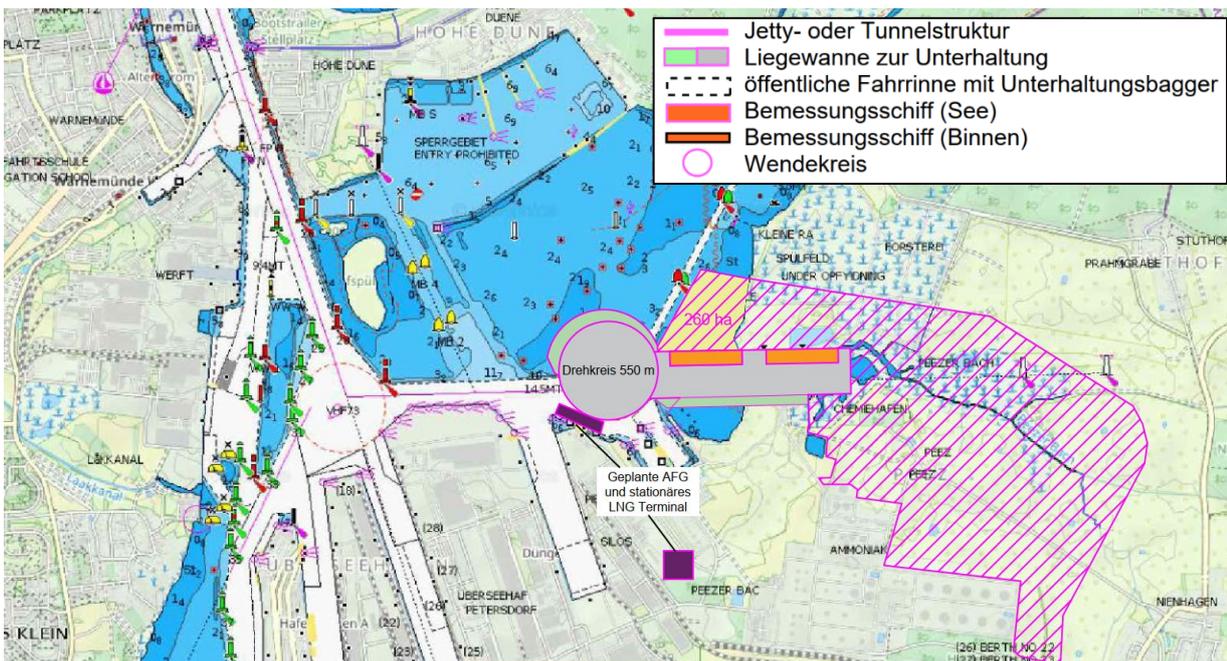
Lageplan Alternative 14: Rostock¹⁹⁹
